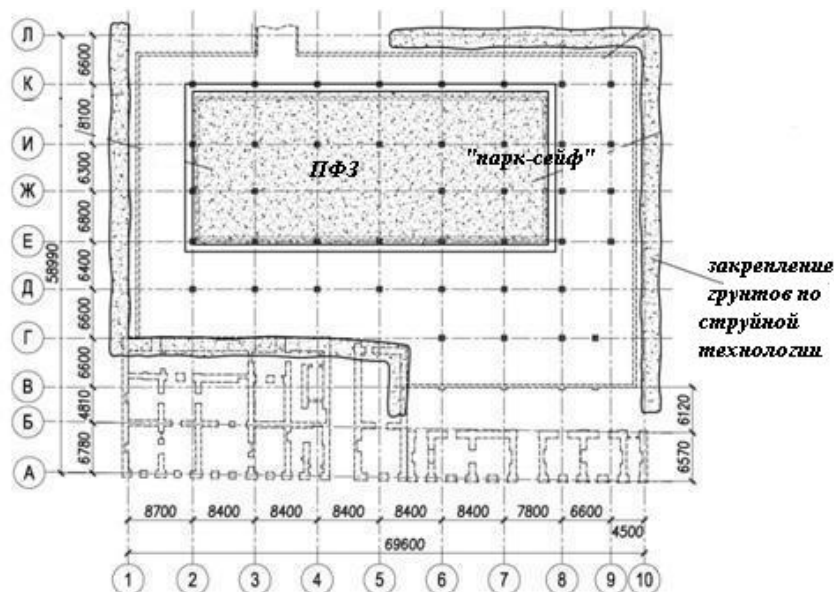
План закрепления грунтов. ПФЗ «парк-сейфа» и усиление фундаментов межевых стен существующих зданий.
